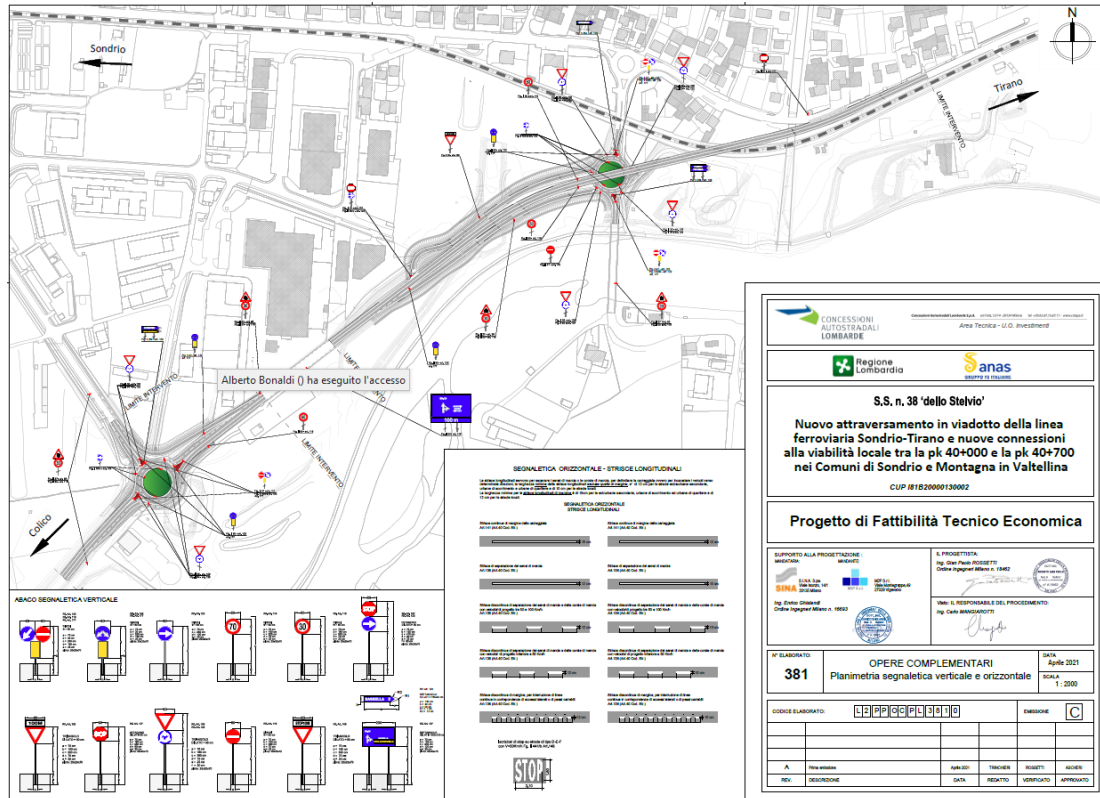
Stralcio planimetria di progetto con segnaletica verticale e orizzontale.
